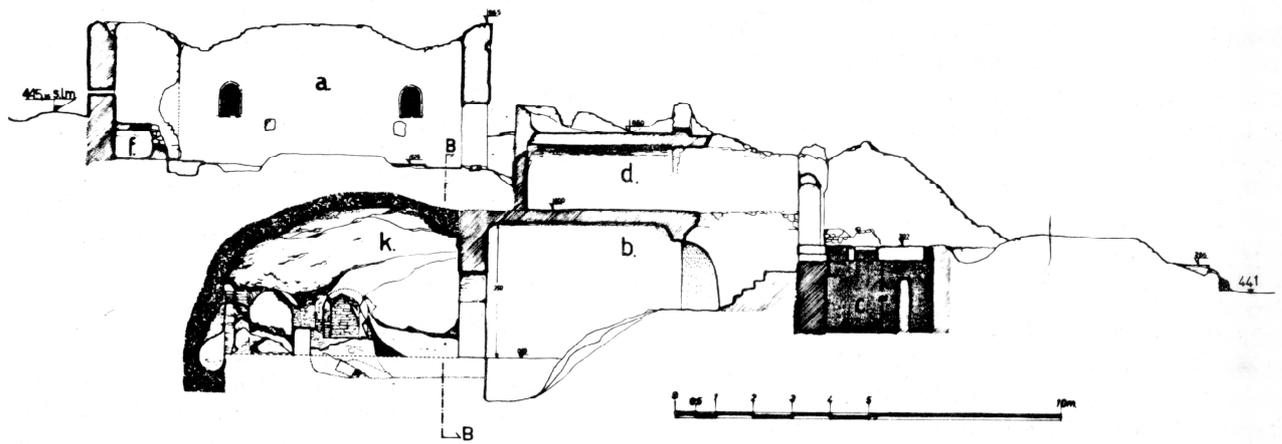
Sezione E-O delle strutture dell'oratorio (fonte: Fiore Cavaliere - Carretta 1988).
